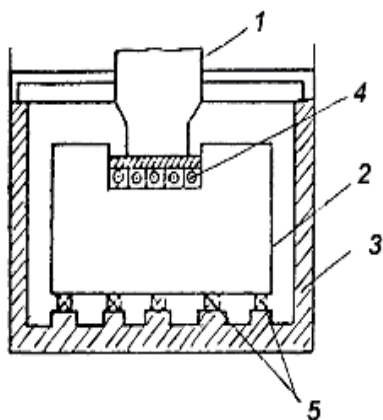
Схема віброізоляції фундаменту під штампувальним молотом: 1 – нижня частина молота; 2 – фундаментний блок; 3 – залізобетонний короб; 4 – підшаботні прокладки; 5 – пружини (гума)
